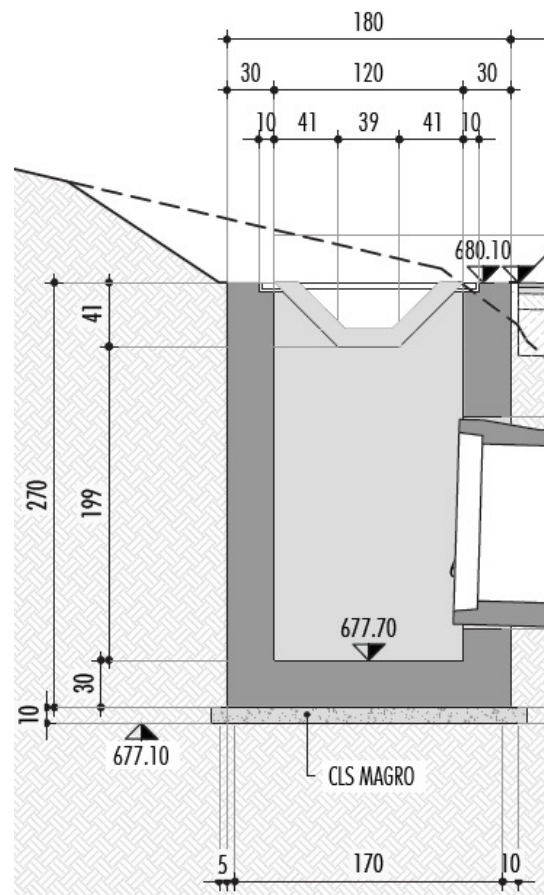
VISTA IN SEZIONE DEL MANUFATTO DI IMBOCCO TIPO
